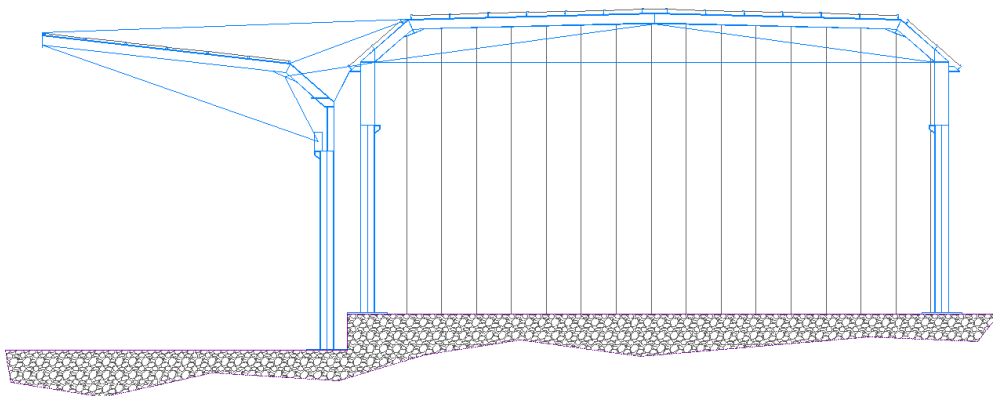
Planimetria nuove strutture previste in progetto (PdC - Capannone e tettoia)
